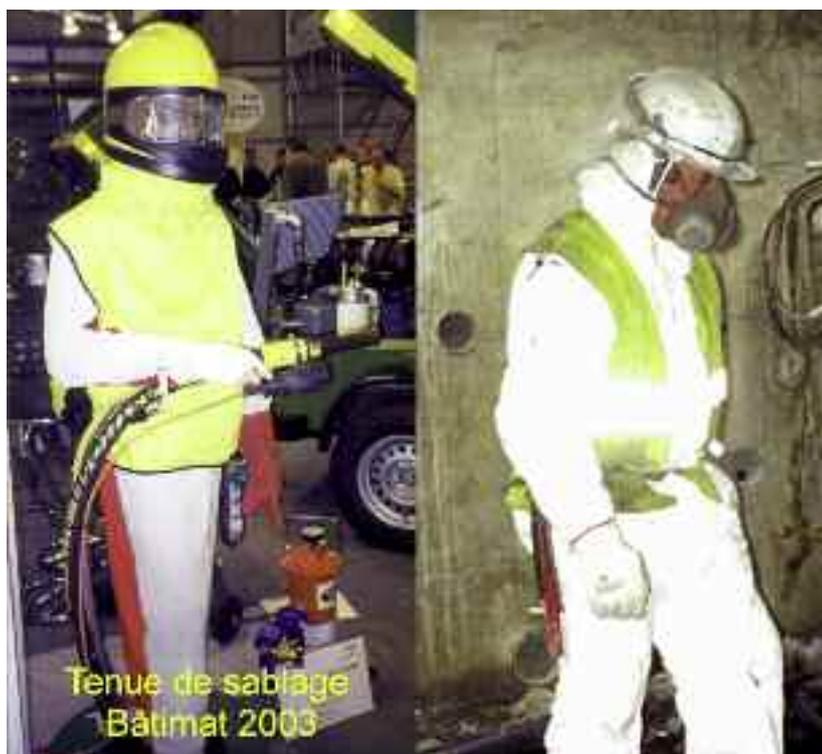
équipements de protection individuelle (crédit photo D. Poineau)
